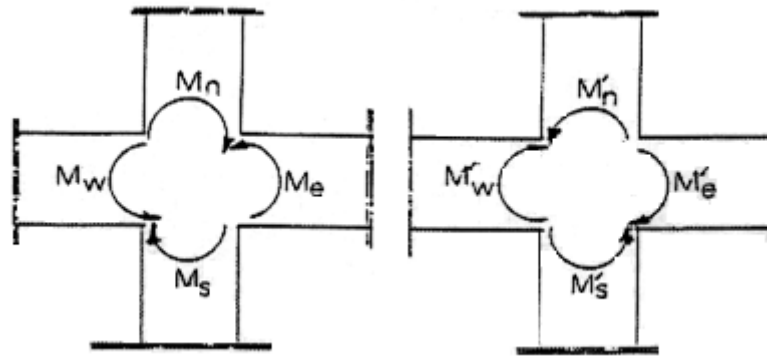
Dimensionnement d'un nœud poutre-poteau.
